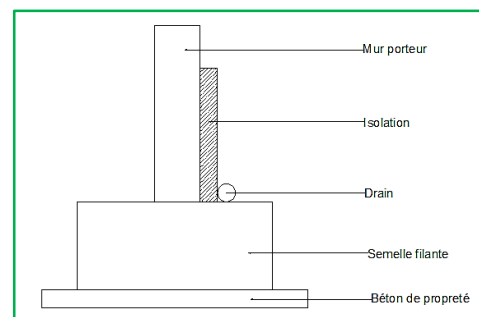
Fondation en semelle filante - Corentin Leroy. Source : [KERNOU Nassim 2016](#)
